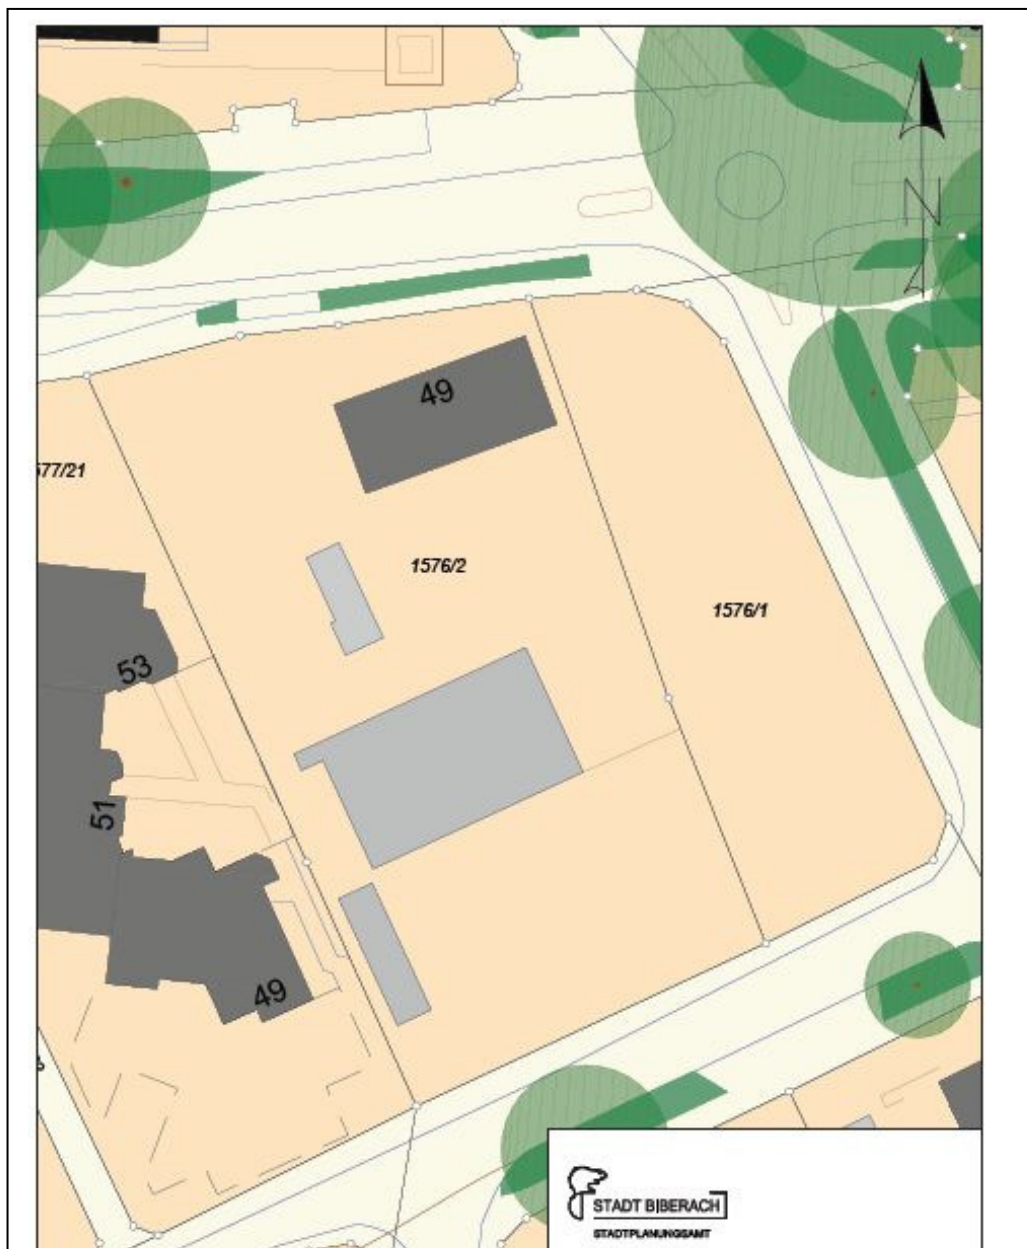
Lageplan zum Vorhabensbezogenen Bebauungsplan (STADT BIBERACH in lit. 2014)
